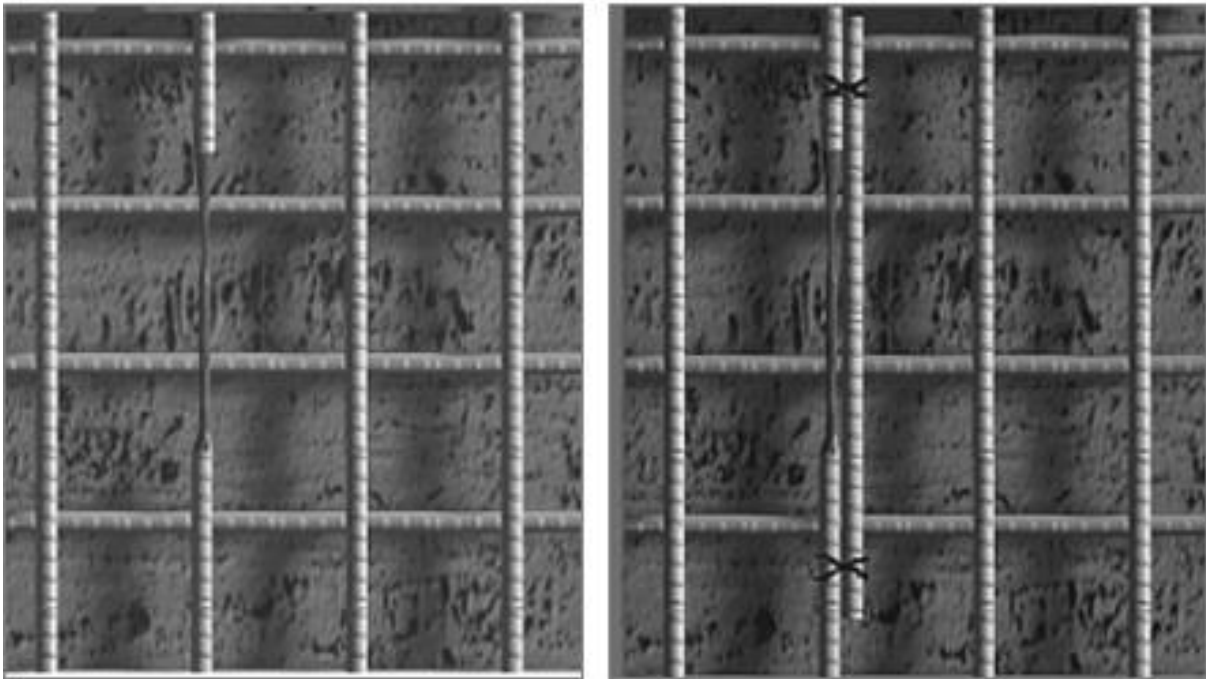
Desgaste y traslape de refuerzo metálico. Fuente: (ACI RAP-5, 2011)
